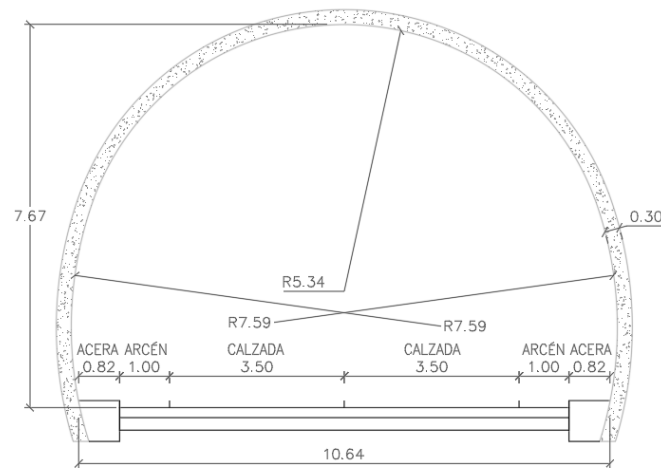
Sección transversal de túnel para la primera alternativa.
